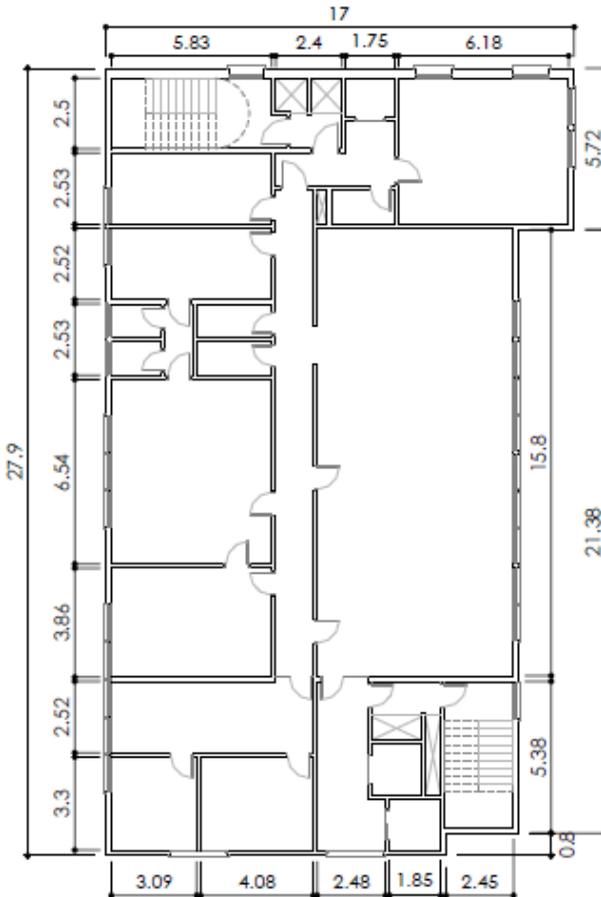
Planta baixa do pavimento Tipo (Spohr, 2008)
